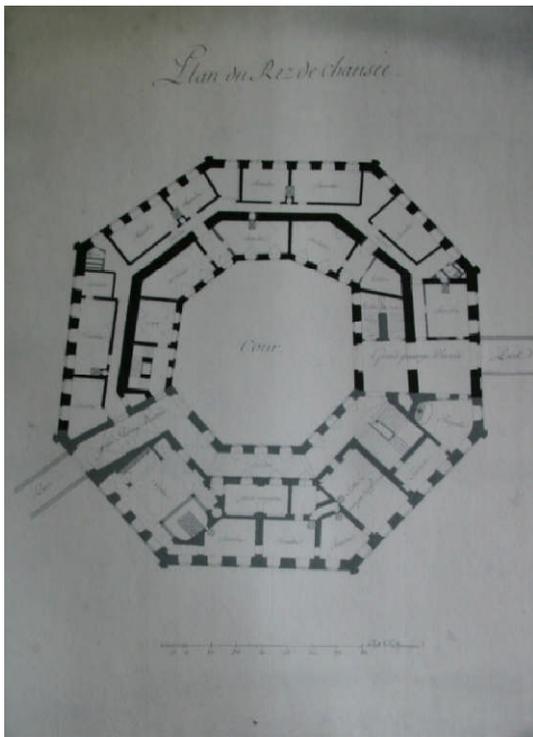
Grundriss Erdgeschoss von Cuvillies
